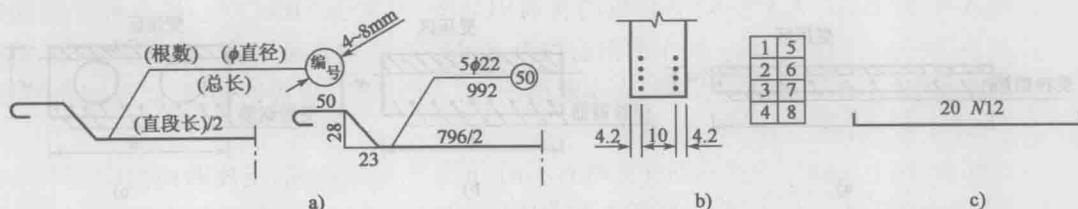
钢筋的标注(尺寸单位:cm;钢筋直径:mm)
